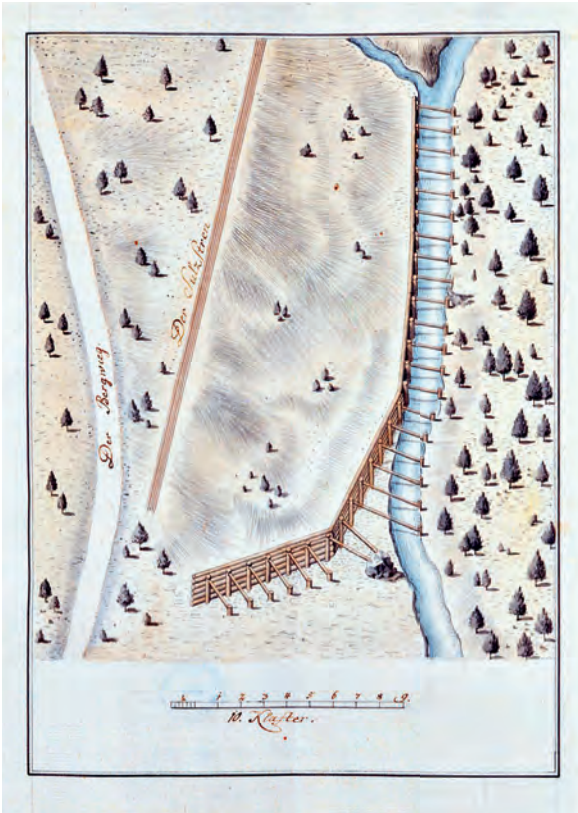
Verbau einer Hangrutschung Salzkammergut (Finanz- und Hofkammerarchiv Wien – Öst. Staatsarchiv, Sign. H 111).
